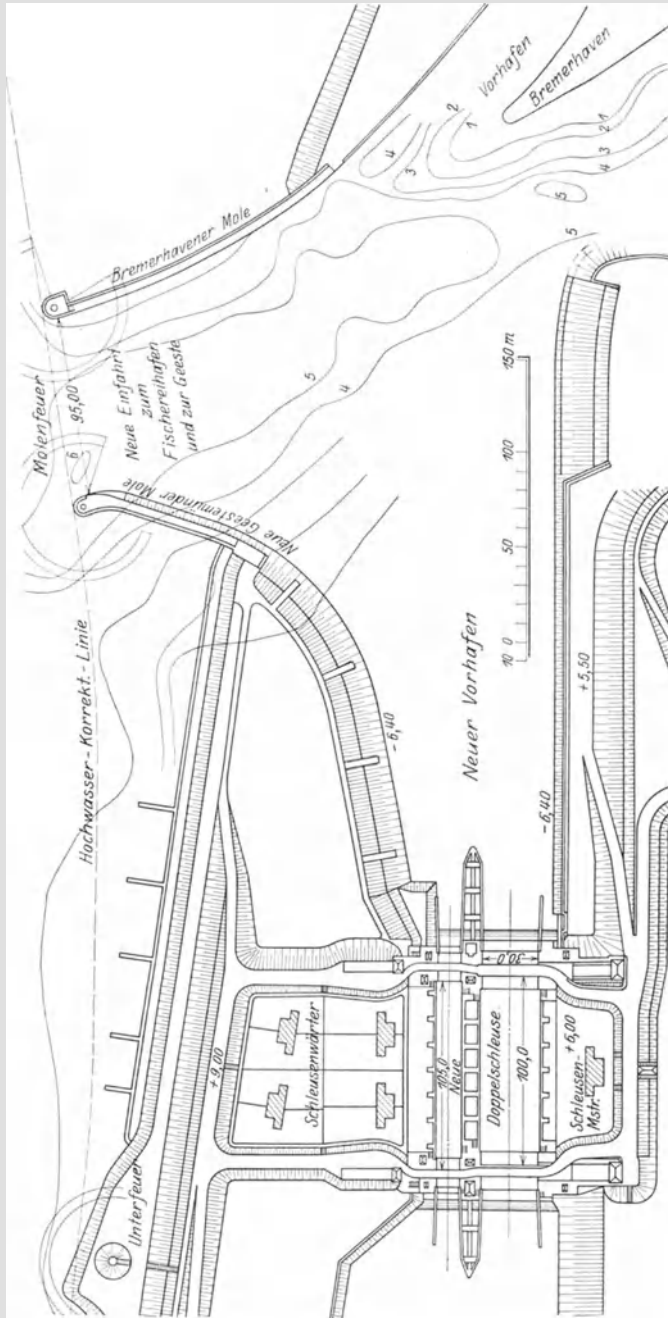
Lageplan der Hafeneinfahrt. Wesermünde (Geestermünde). Maßstab 1 : 4000.
